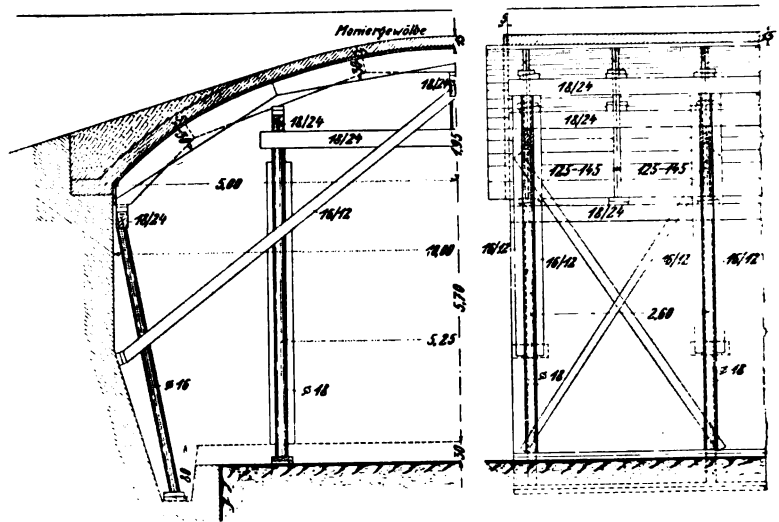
Eingerüstung der Wiener Stadtbahn.
